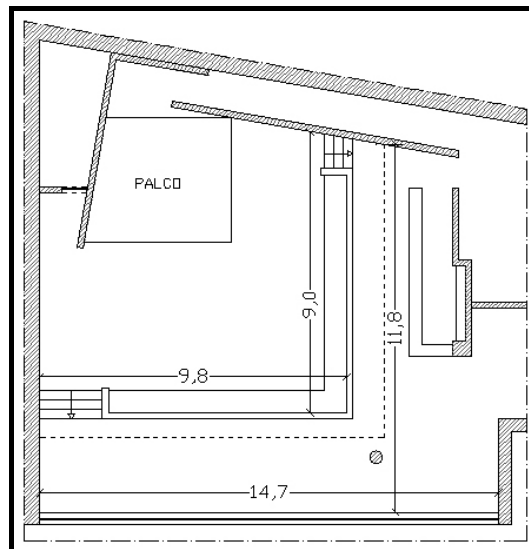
Planta do Café-Concerto da Casa das Artes
